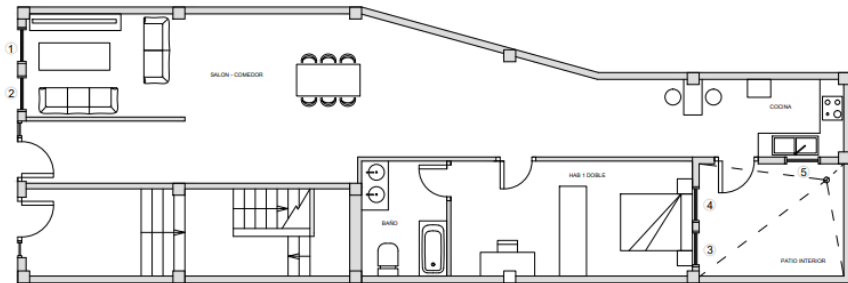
Plano Iluminación y ventilación. Fuente: Propia.
